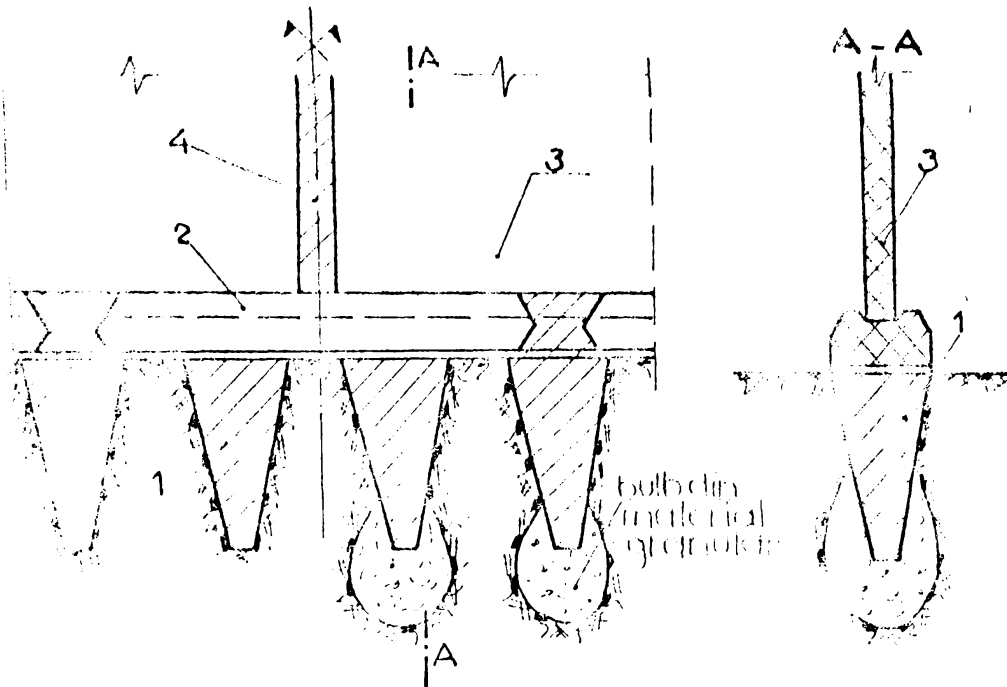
Fundații continue sub pereți realizate pe colțari: 1) colțar din beton simplu (cu sau fără bulb) 2) talpă prefabricată sau monolită; 3) elevație prefabricată; 4) monolitizarea elevațiilor prefabr.
